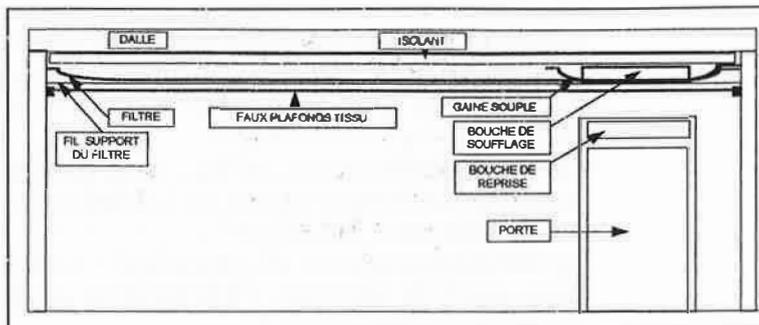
Vue du faux plafond, des fentes de soufflage et reprise en imposte de porte.
